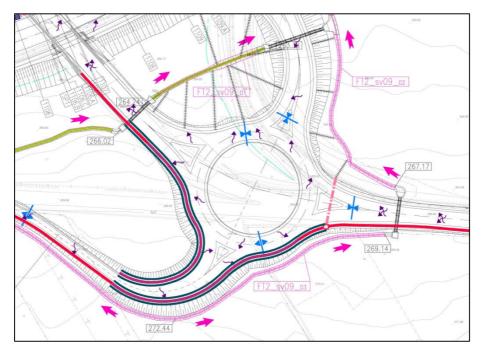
Stralcio di planimetria idraulica con riportate le trincee drenanti (doppia linea blu)
